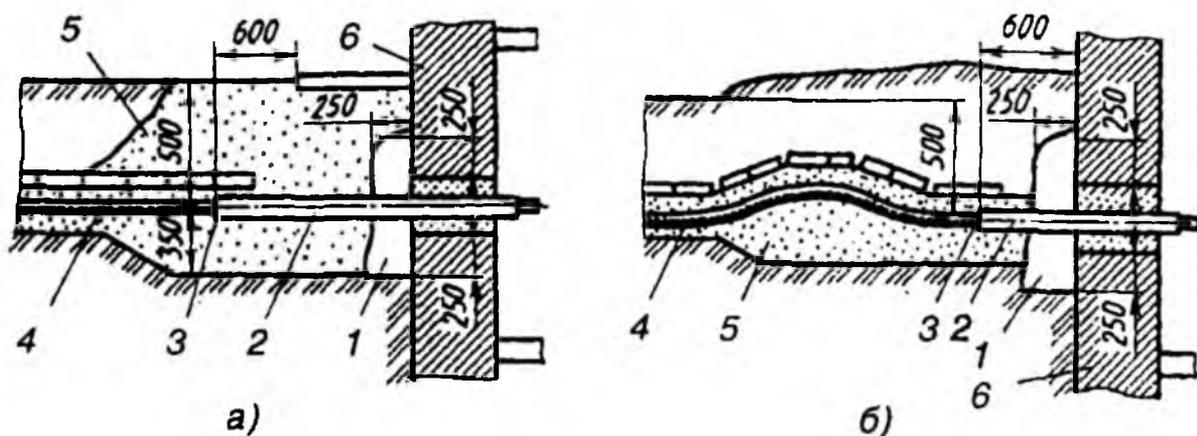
Ввод кабелей из траншеи в здание или кабельное сооружение:
